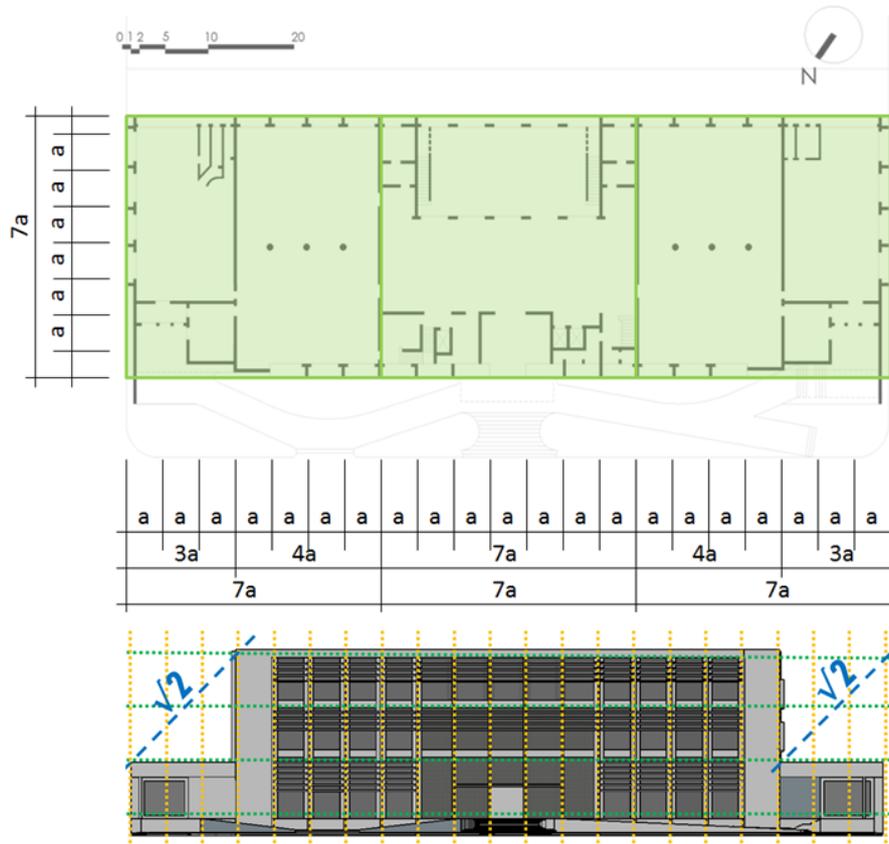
Biblioteca Pública do Paraná, planta do térreo e elevação principal com intervenção gráfica da autora.
